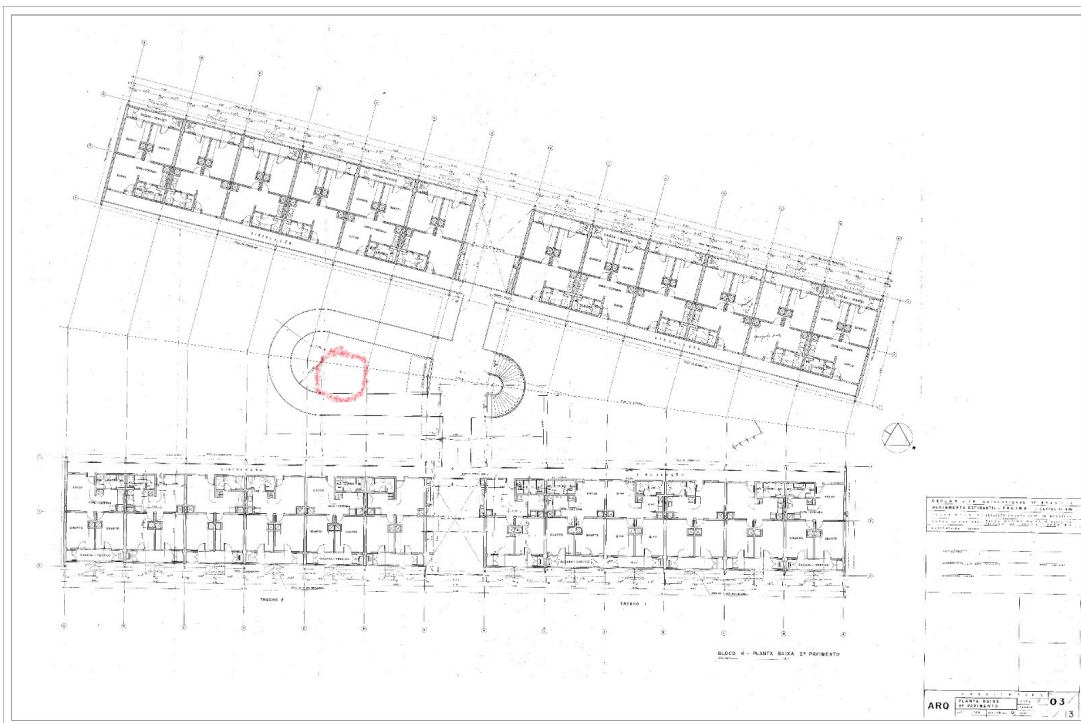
Planta Baixa 2º Pavimento do Alojamento Alunos da PG . Colina UnB
